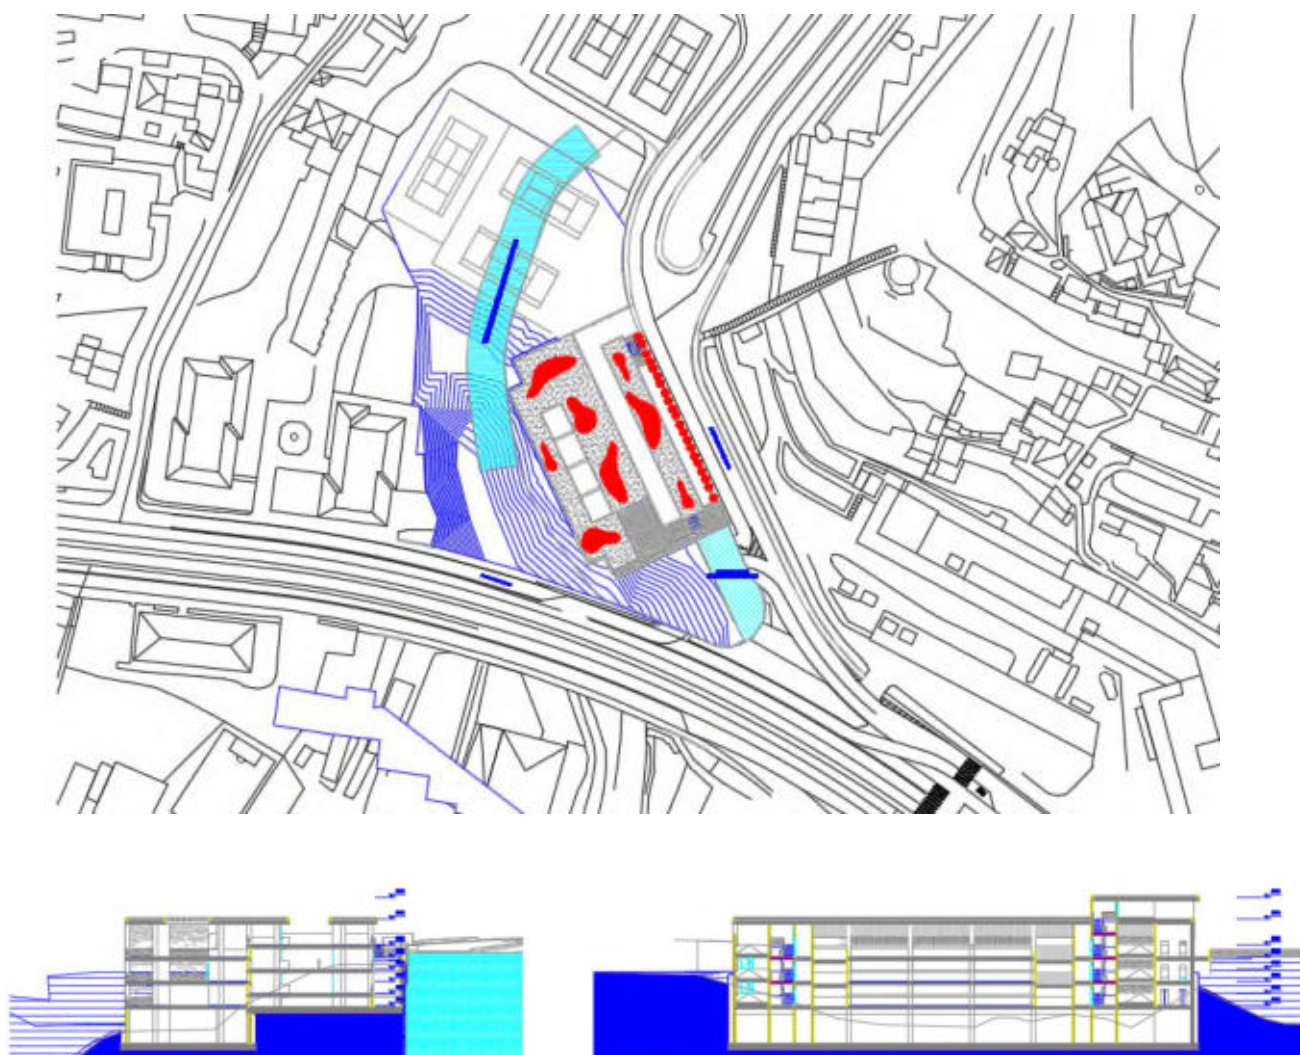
Planimetria e sezioni del parcheggio Campanule
